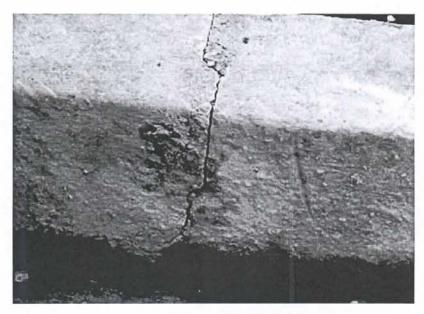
Emboquillado fisurado. (Calle Max Casas, Tramo II cercano a la esquina de calle Lautaro)
